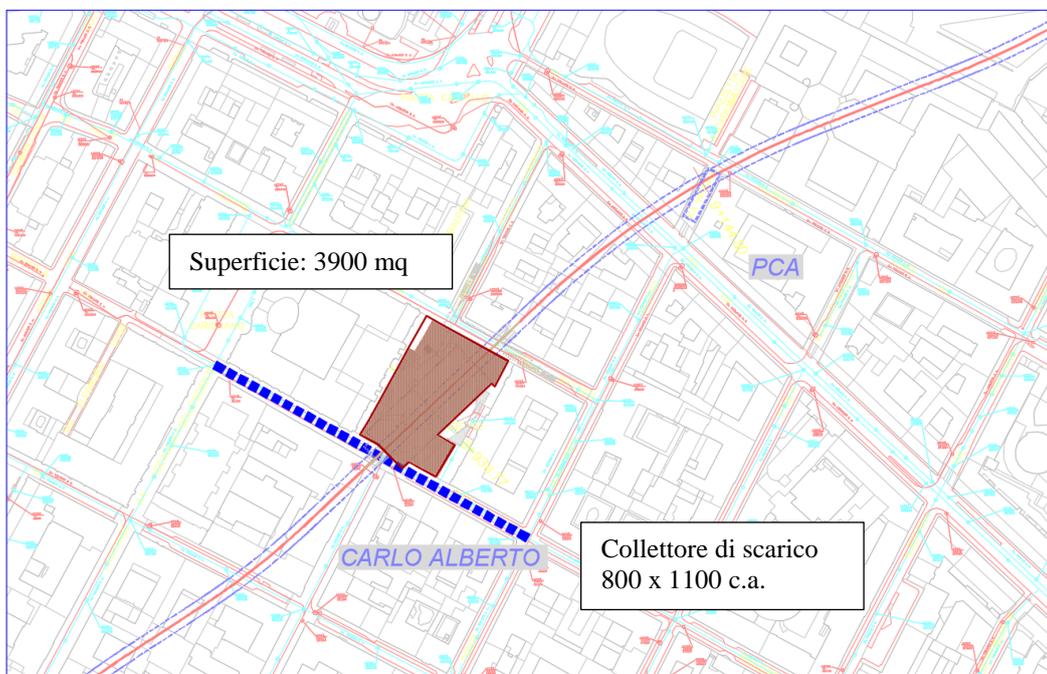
Aree di cantiere – Stazione Carlo Alberto – FASE 1
